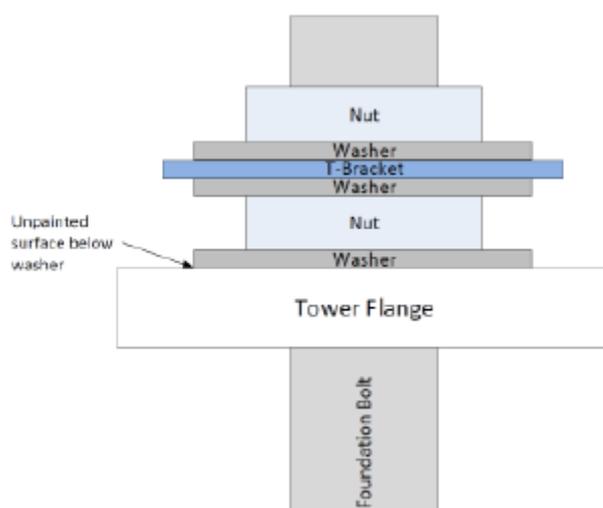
Esempio di ordine di montaggio – utilizzando la staffa a T
